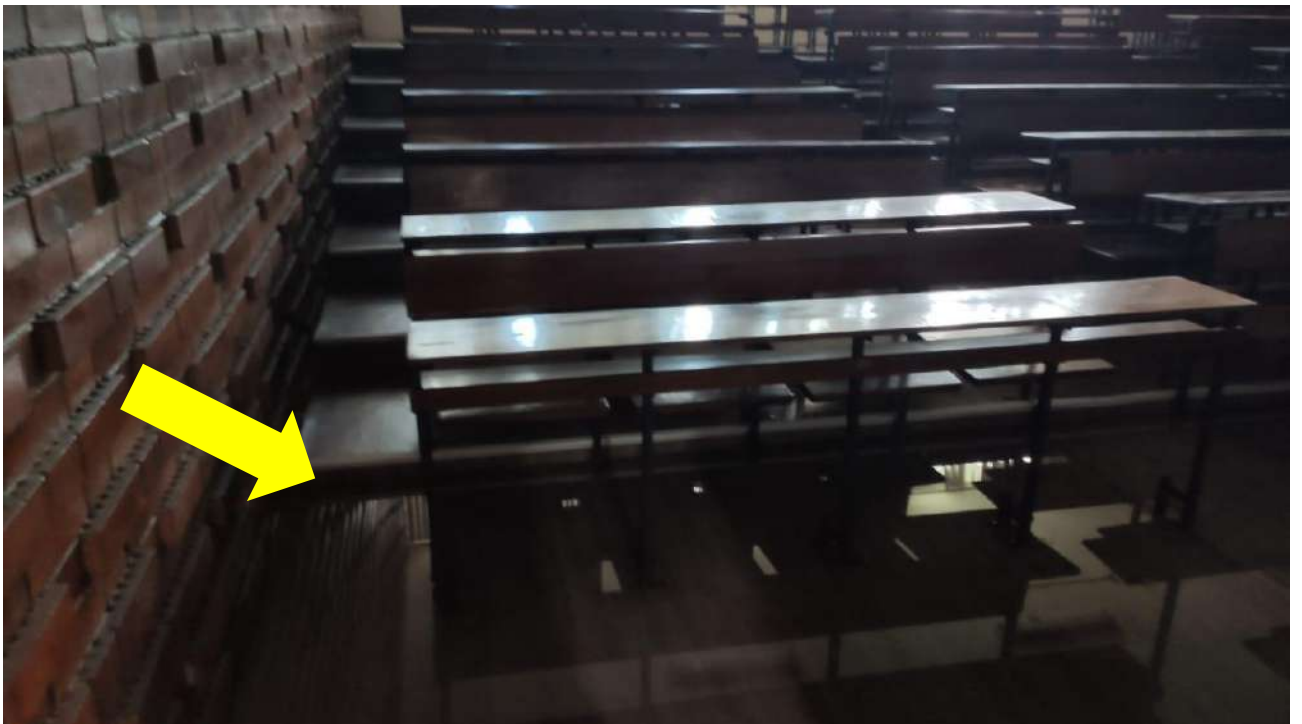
Piso danificado por alagamento (Apoio Acadêmico CCSA 1º pavimento)
